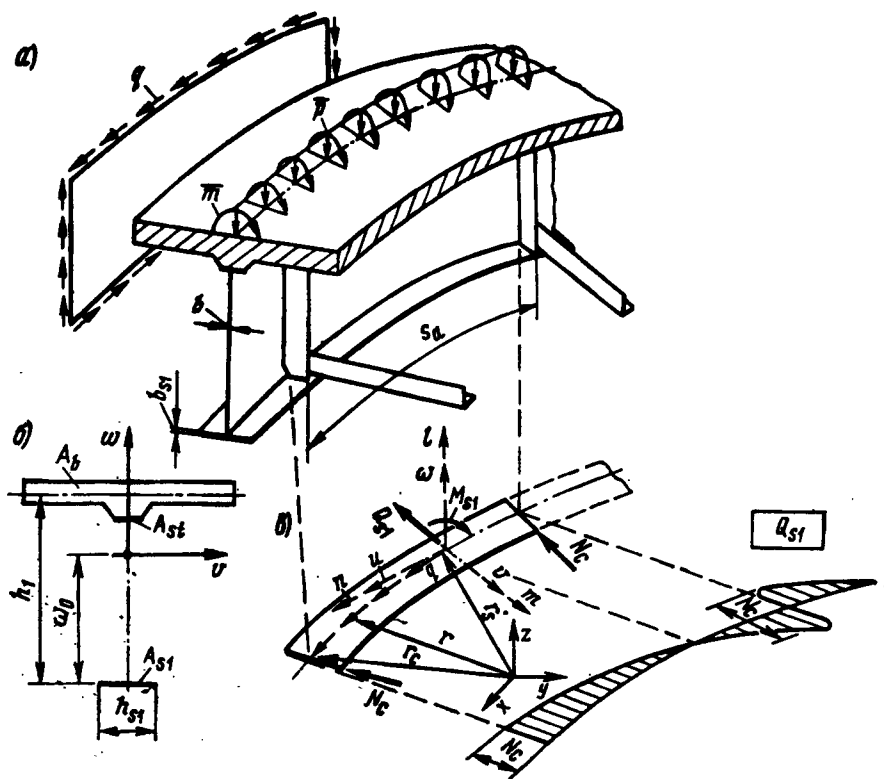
Схема для расчета сталежелезобетонной балки
